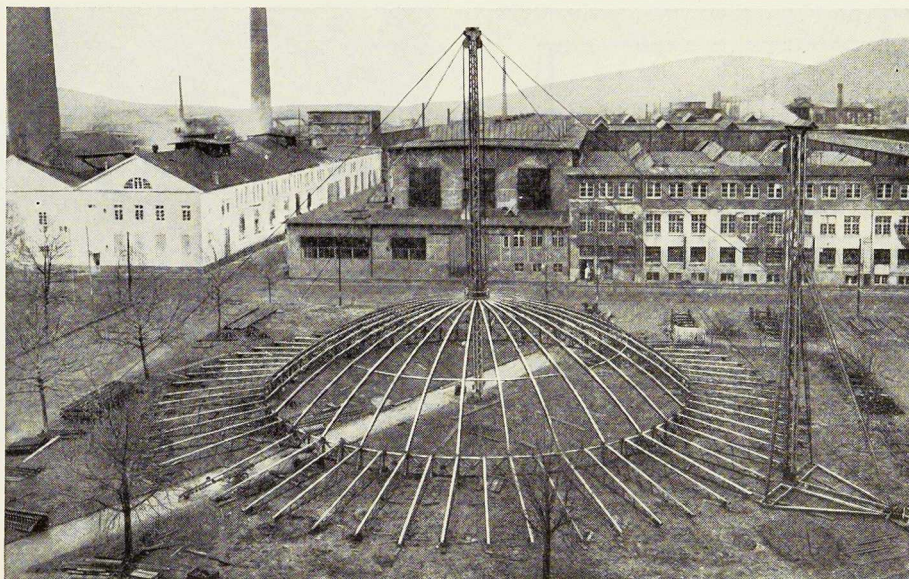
Coupole du cirque après assemblage des poutres de la toiture oblique.
